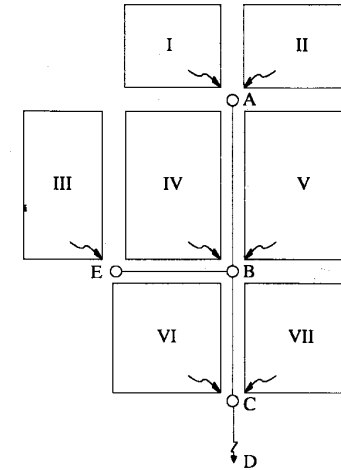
Cuenca de drenaje y sistema de alcantarillado de aguas lluvias para los ejemplos 15.1.1 y 15.1.2.
